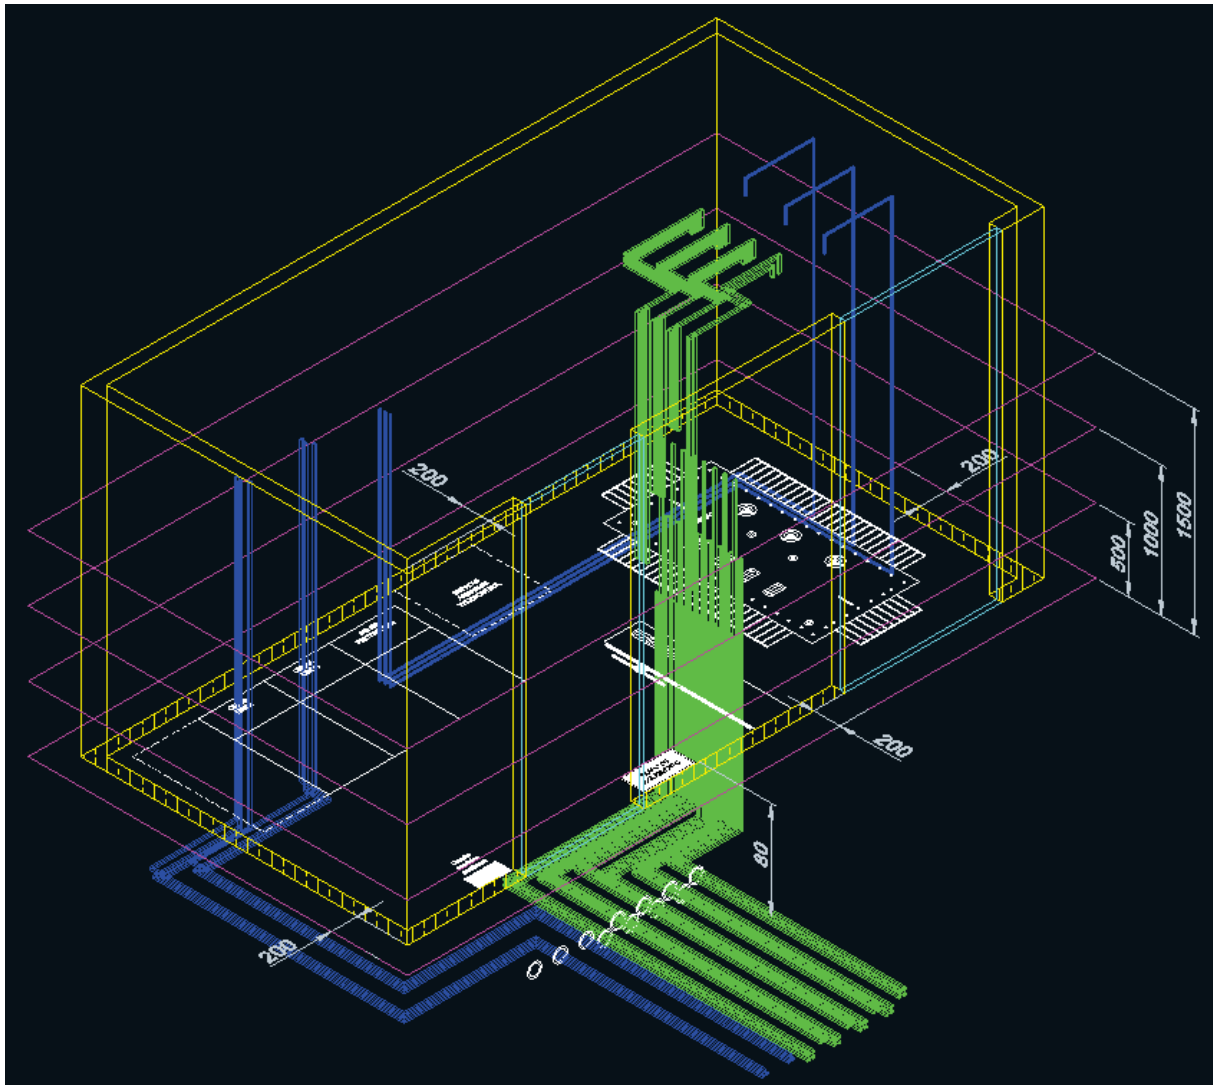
Vista isométrica de la instalación (2L+1T [Sup]) (cotas en mm).
